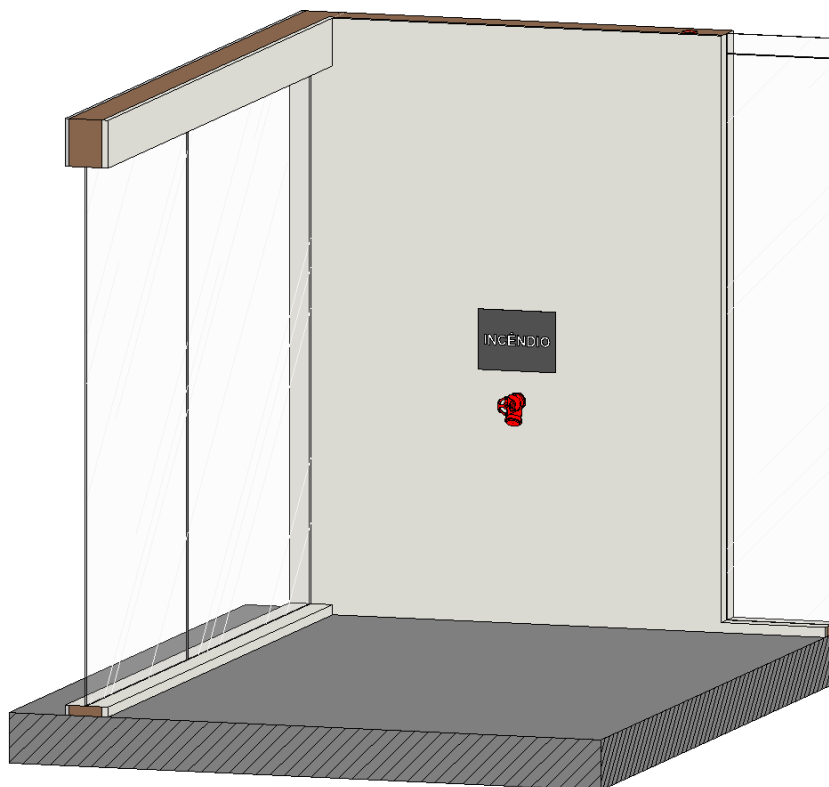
Posicionamento do Abrigo de Hidrante no Pavimento Tipo
